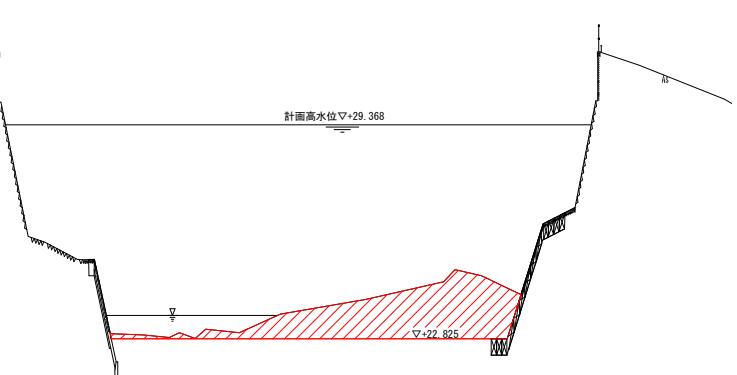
C-C断面図 (11.6k 付近(No.103))
